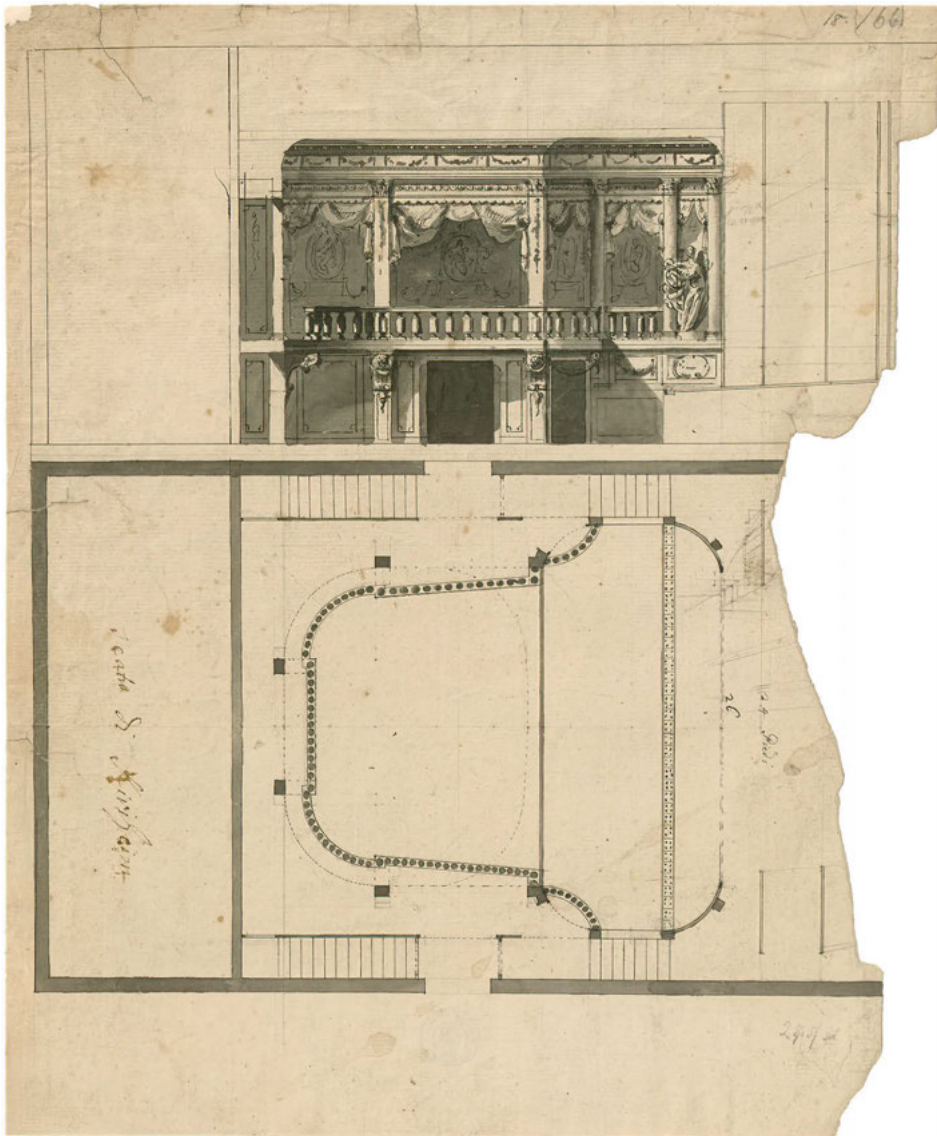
Giosué Scotti: *Teatro di Kirchein*, Grundriss und Längsschnitt, Feder, laviert. Ludwigsburg, Ludwigsburg Museum, 515.
